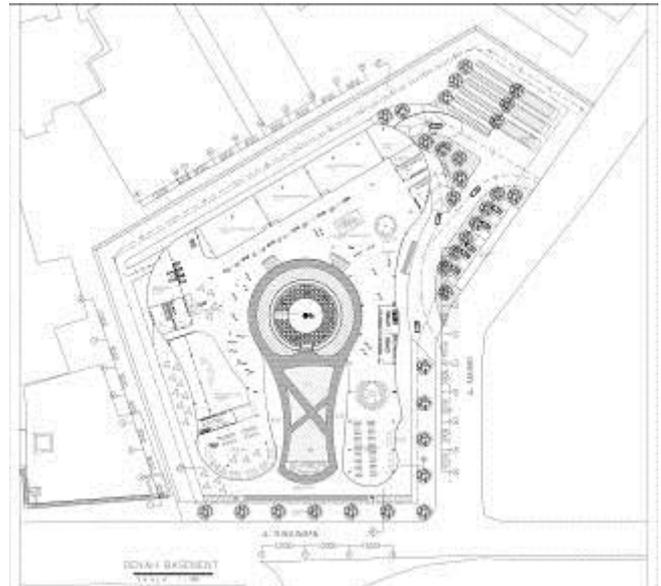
Zoning bangunan. Sumber: pribadi
